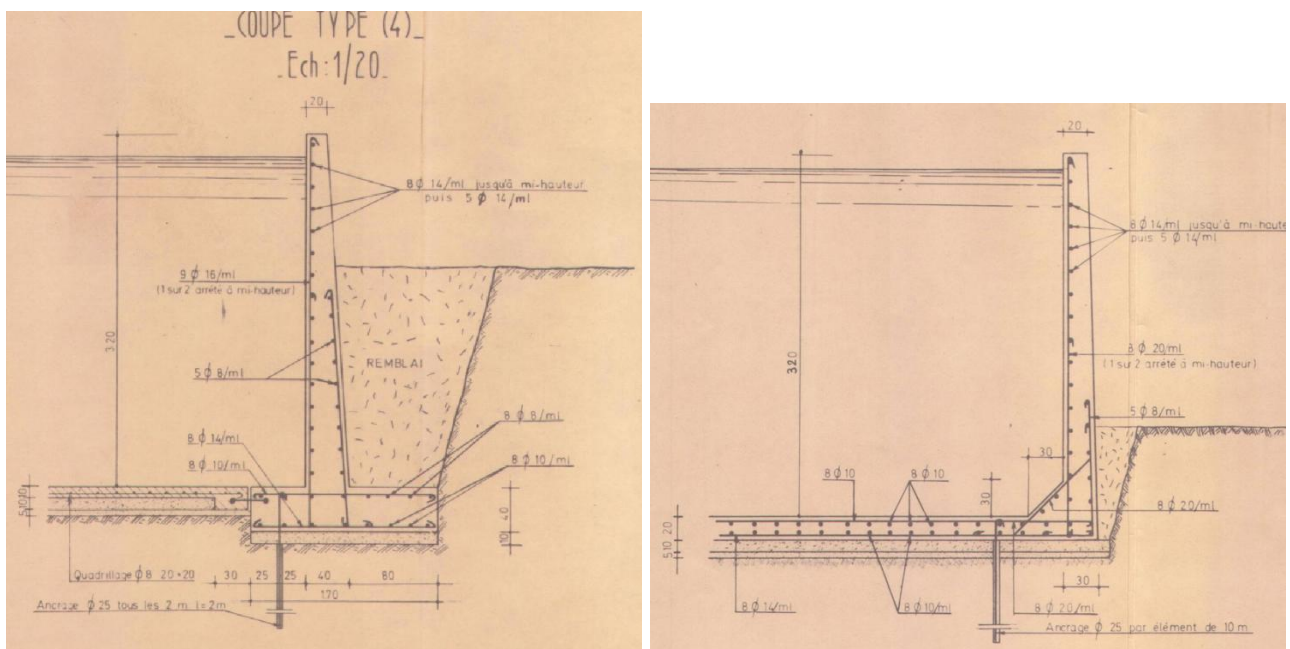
Ferrailage du radier et des bajoyers dans le coursier bétonné (à gauche dans la partie amont du coursier bétonné, à droite dans sa partie aval) - Plan de projet
